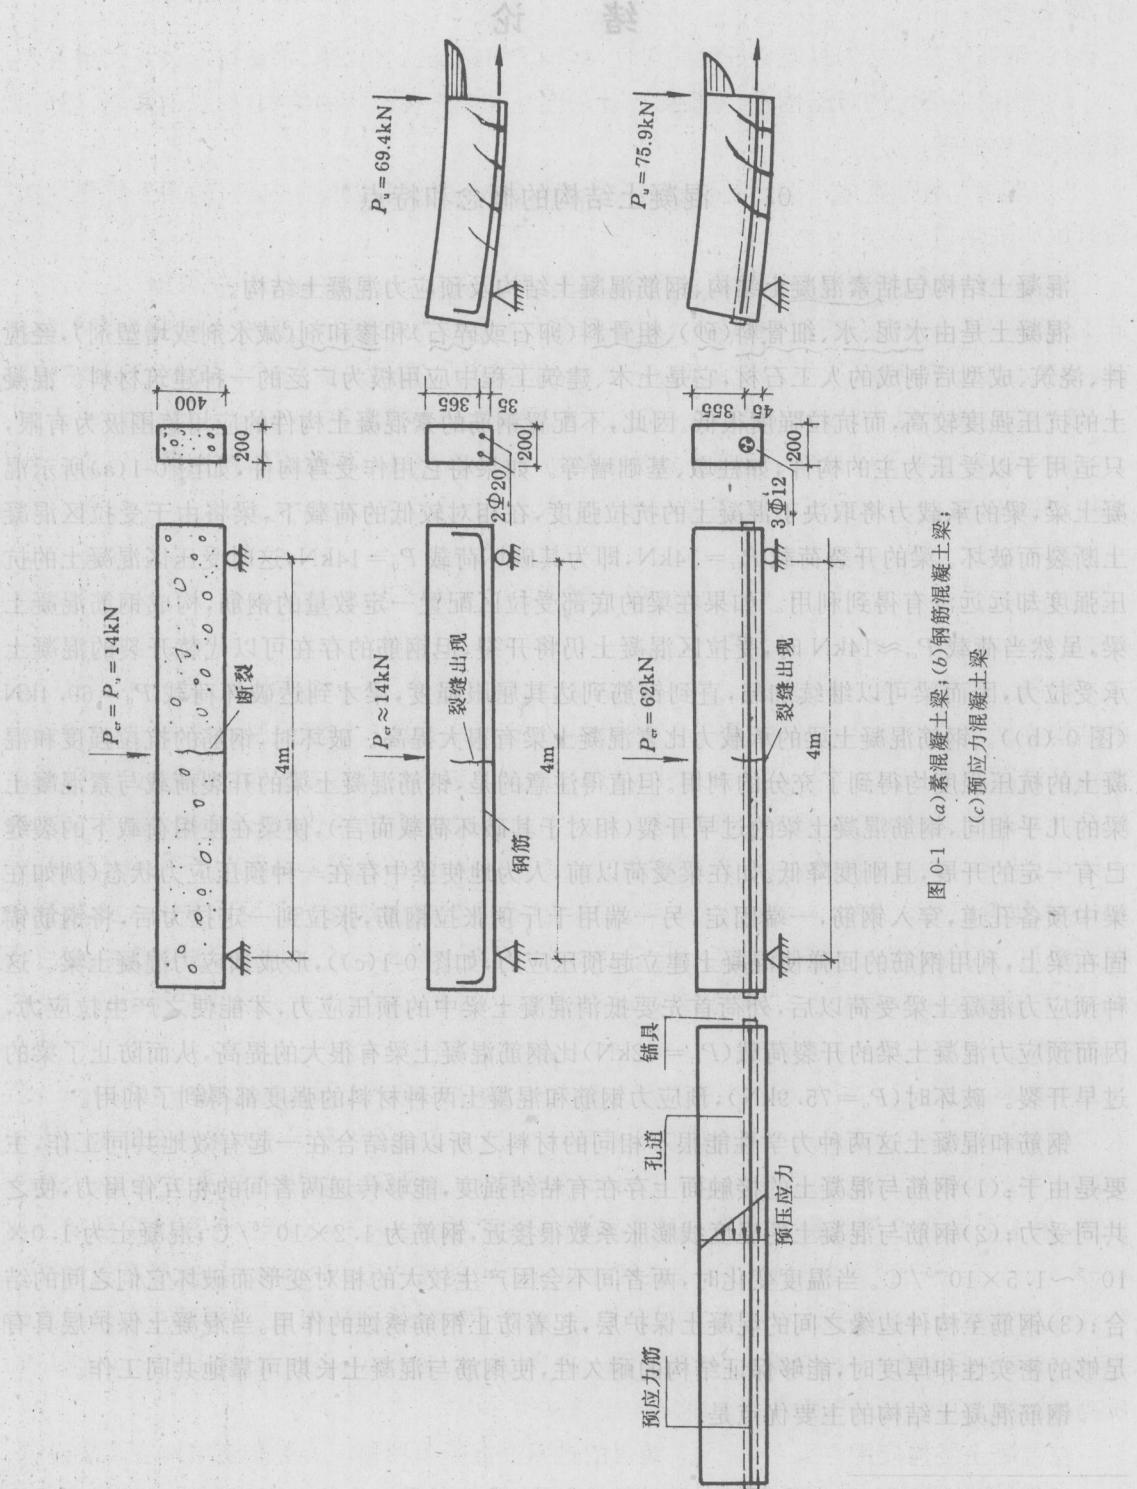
(a) 素混凝土梁; (b) 钢筋混凝土梁;
